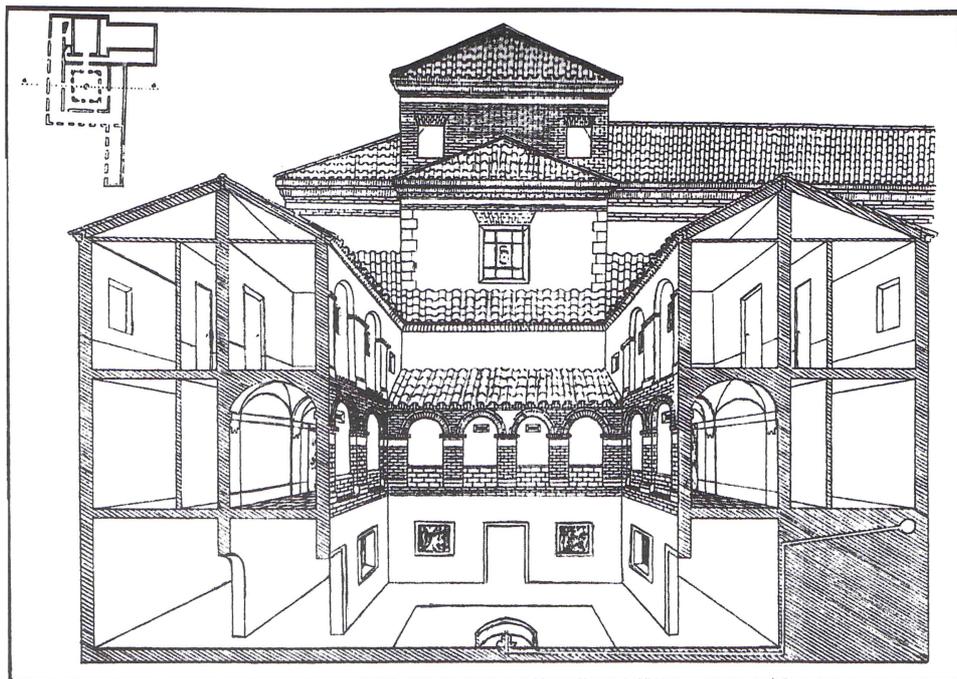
Dibujo esquemático de la estructura y disposición que, probablemente, tuvo el convento a la vista de lo que hoy queda del edificio. Sección con el corte por el centro en dirección norte-sur.
